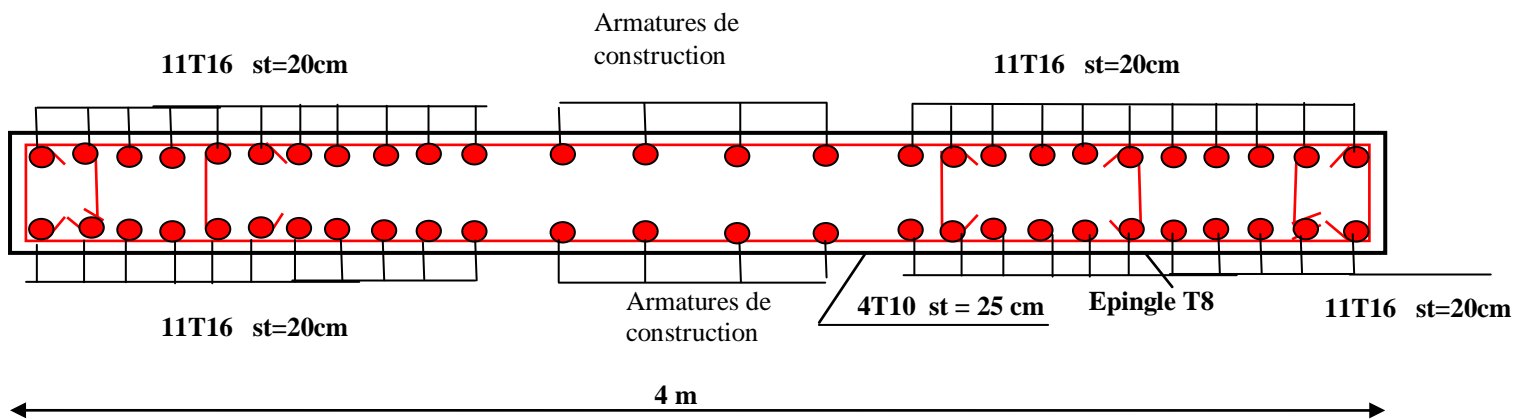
Schéma exemple de ferrailage du voile Vy3 au RDC
